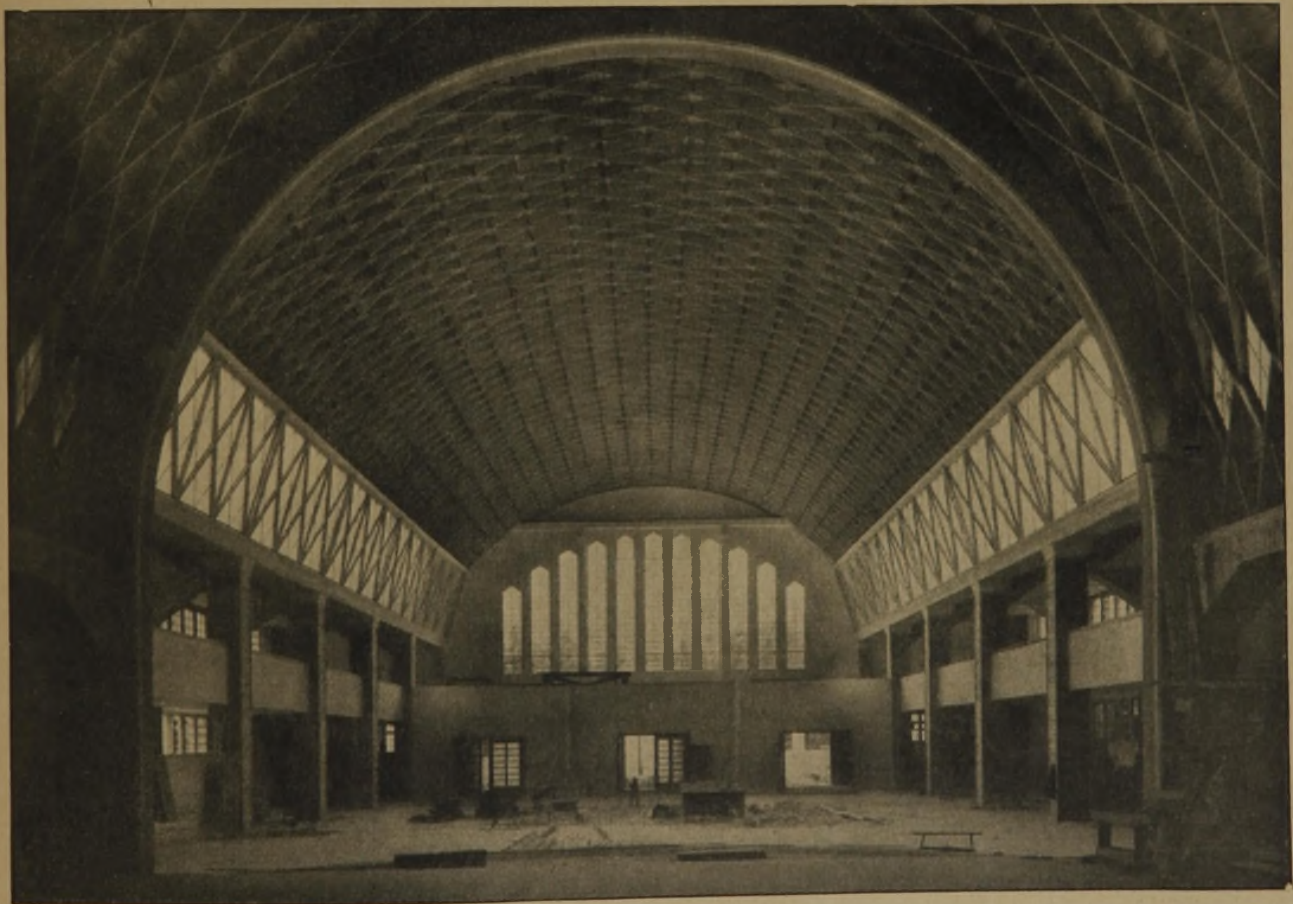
Innenansicht der Haupthalle. Dach in Lamellen-Zollbauweise.
